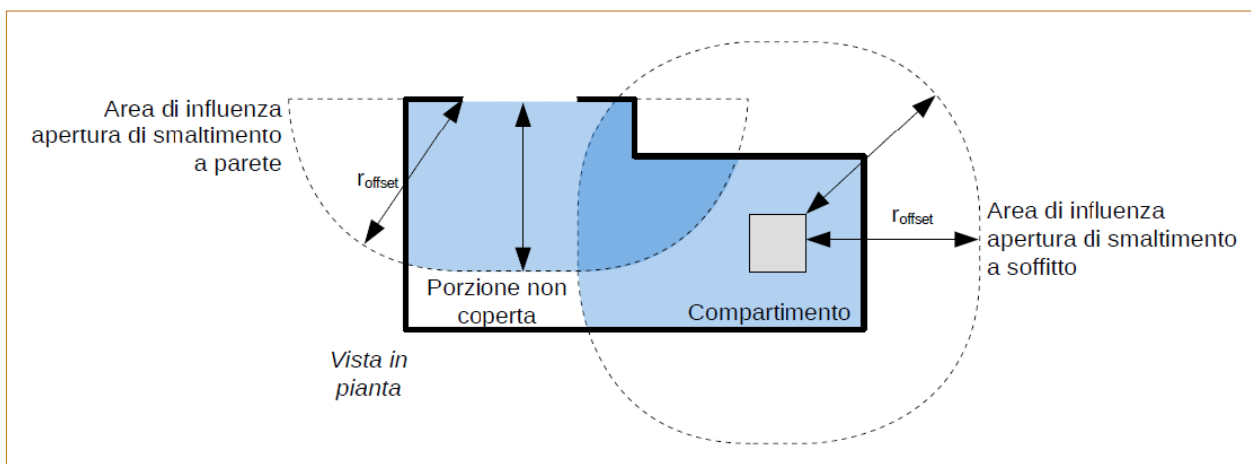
Verifica dell'uniforme distribuzione in pianta delle aperture di smaltimento
